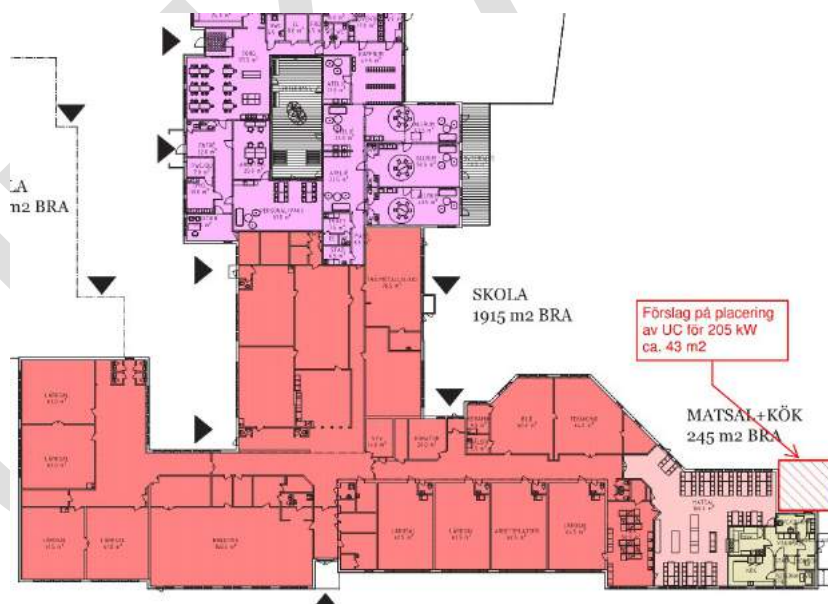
Förslag till placering av ny UC enligt ovanstående dimensioner
